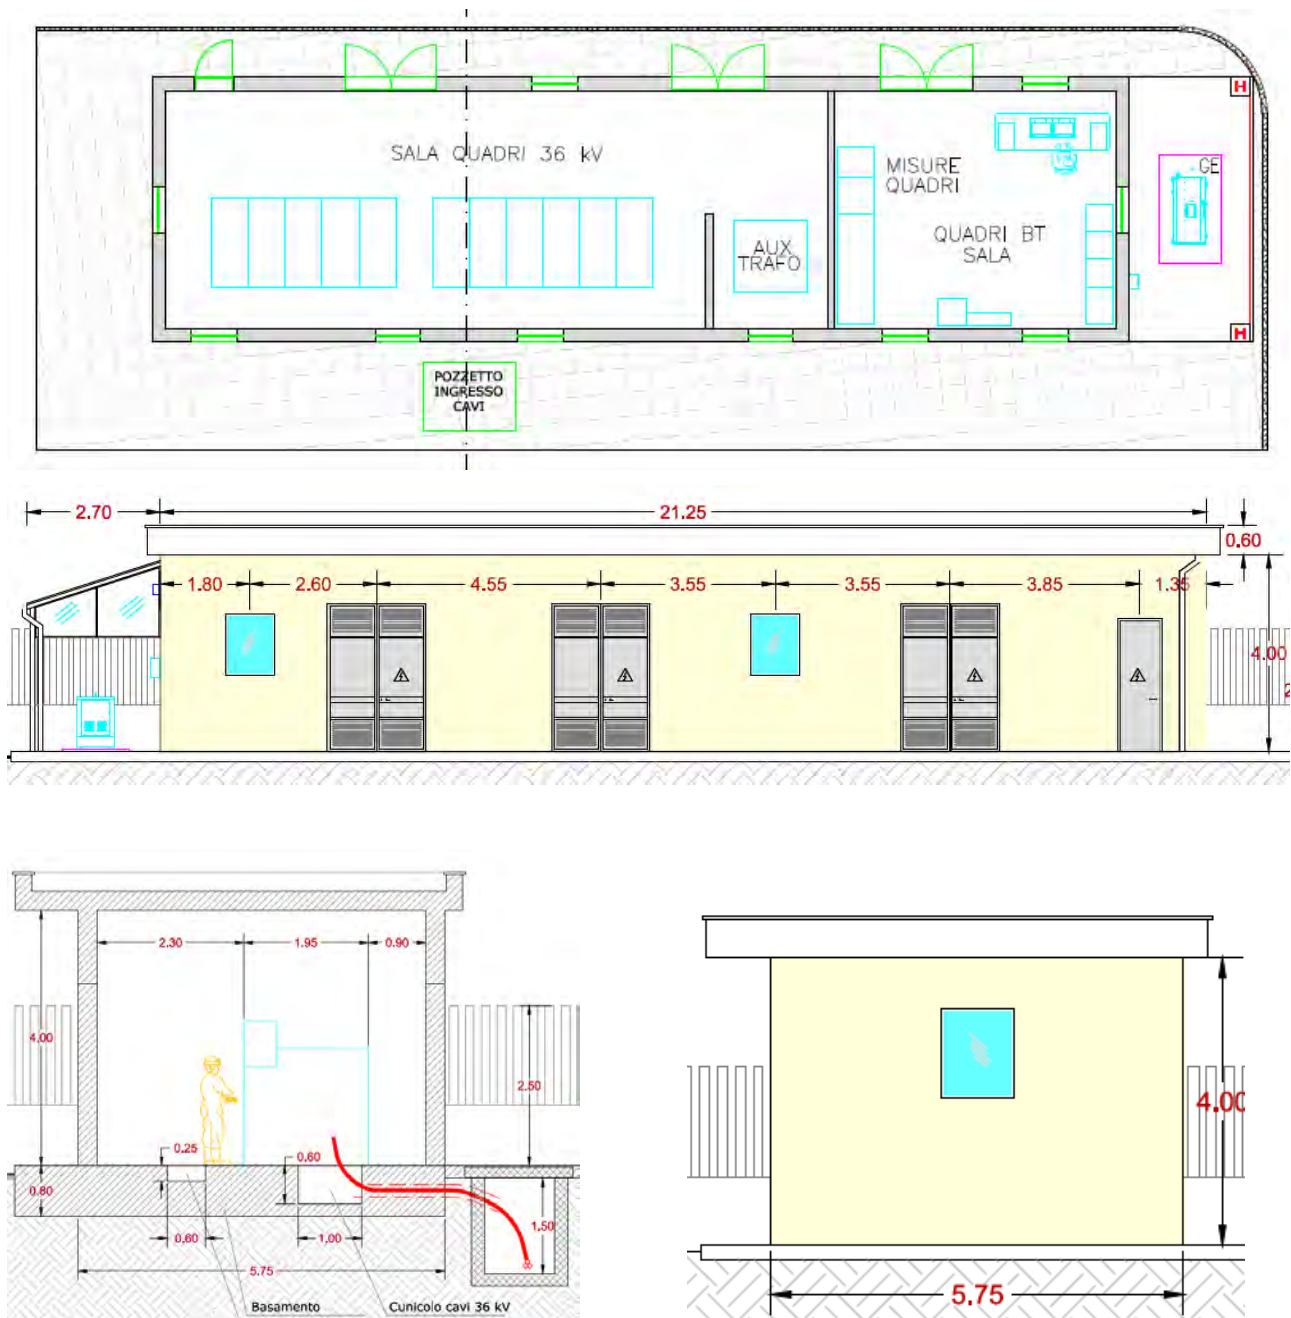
viste edificio di comando – planimetria, prospetti, sezione
